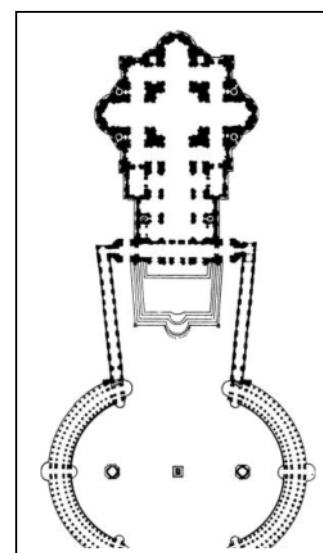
Plan de la place St-Pierre, à Rome (1574 –1656). Source : Leonardo Benevolo, 1994.
